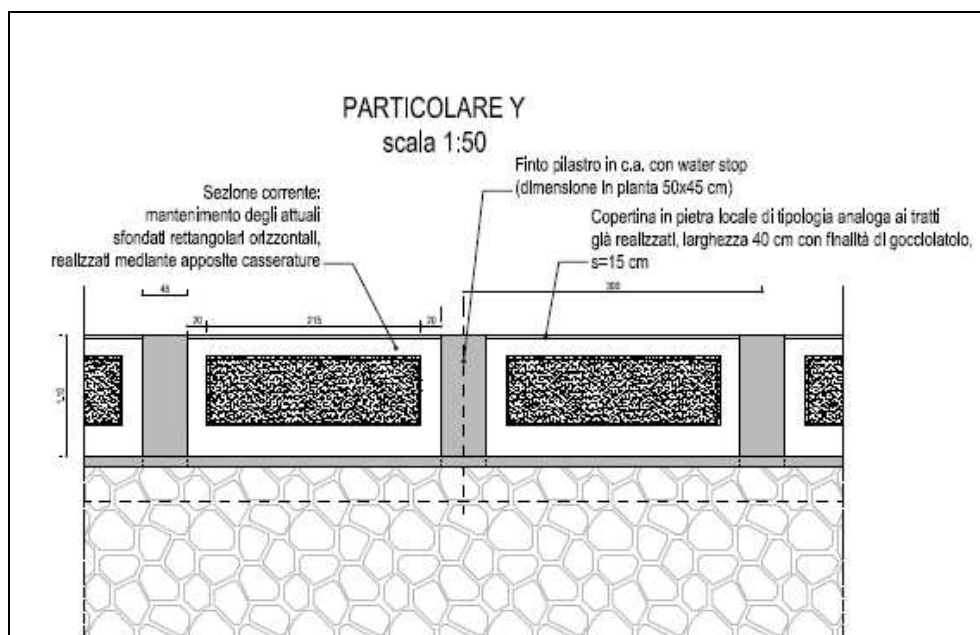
Particolare nuovo parapetto (vedi Tavola DRS 3017).
